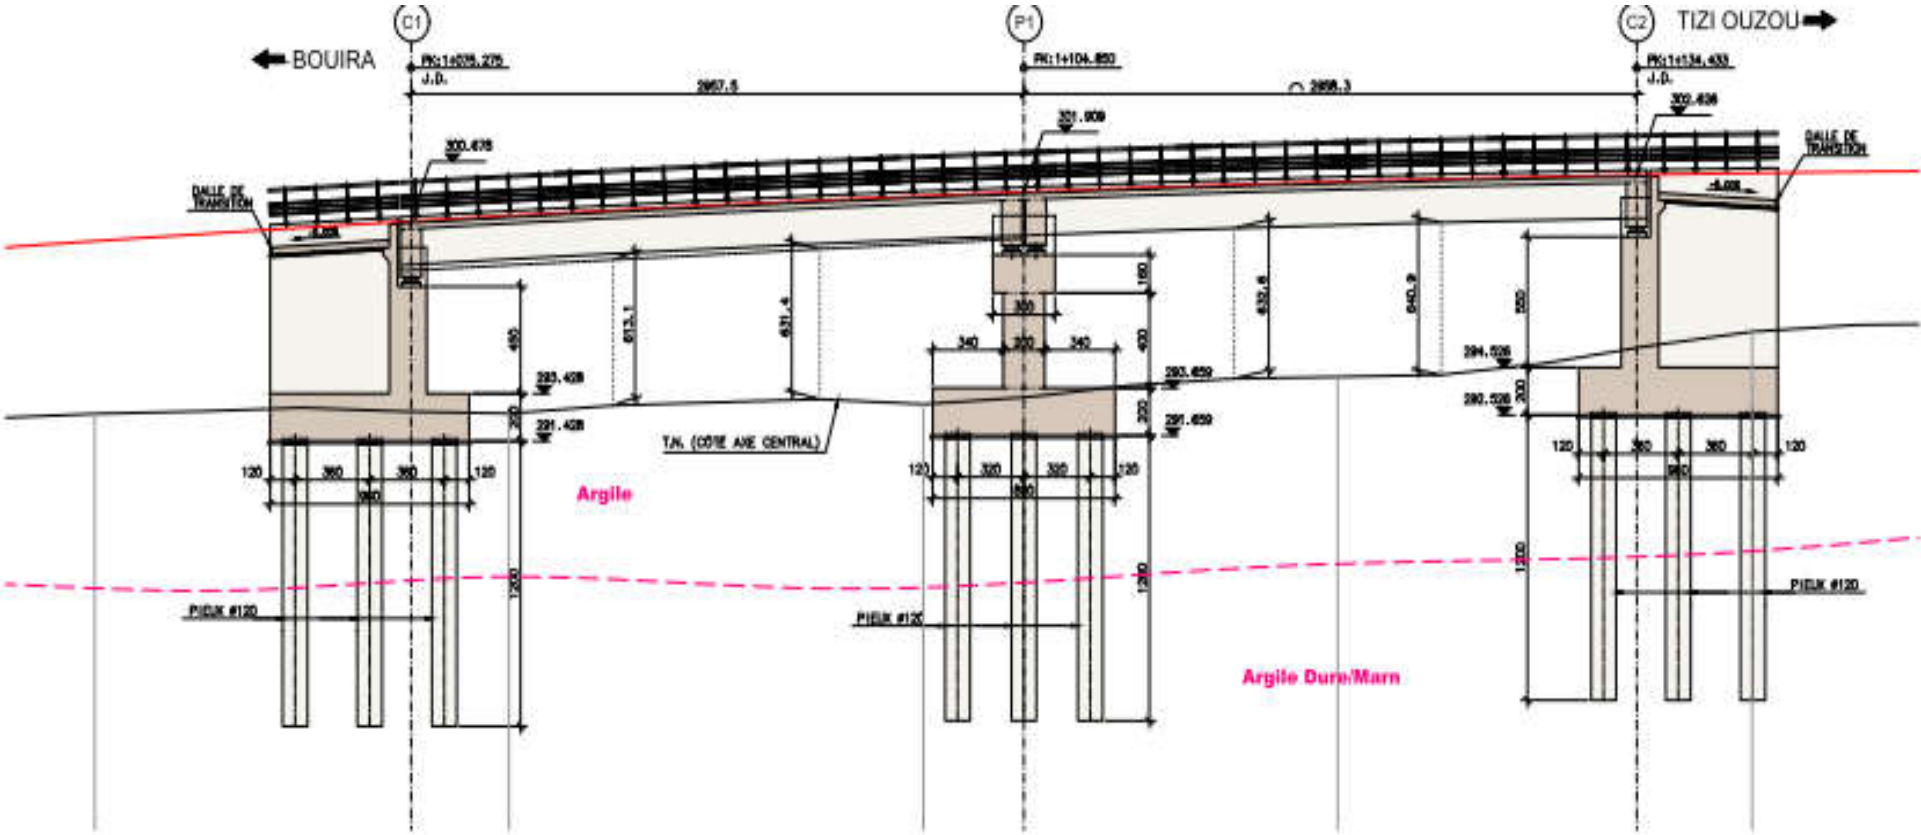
Coupe longitudinale de l'ouvrage (profil en long)
